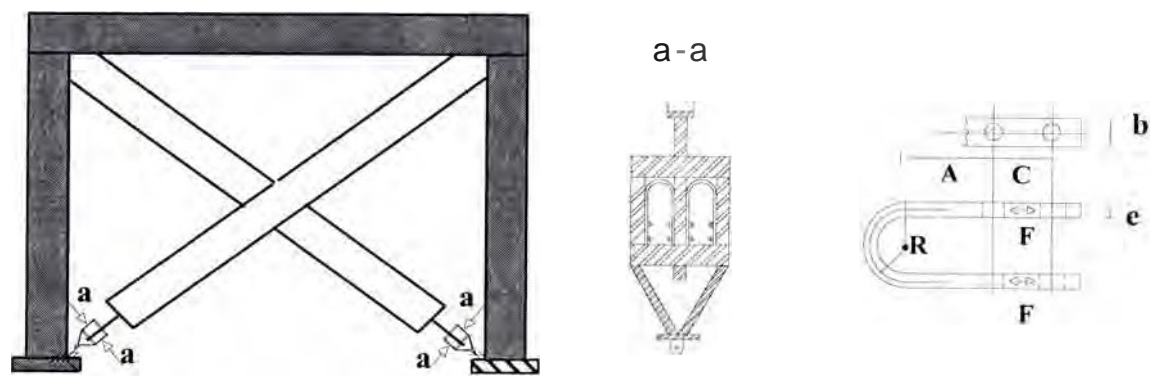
Colocación, montaje y geometría típica de los dispositivos solera
